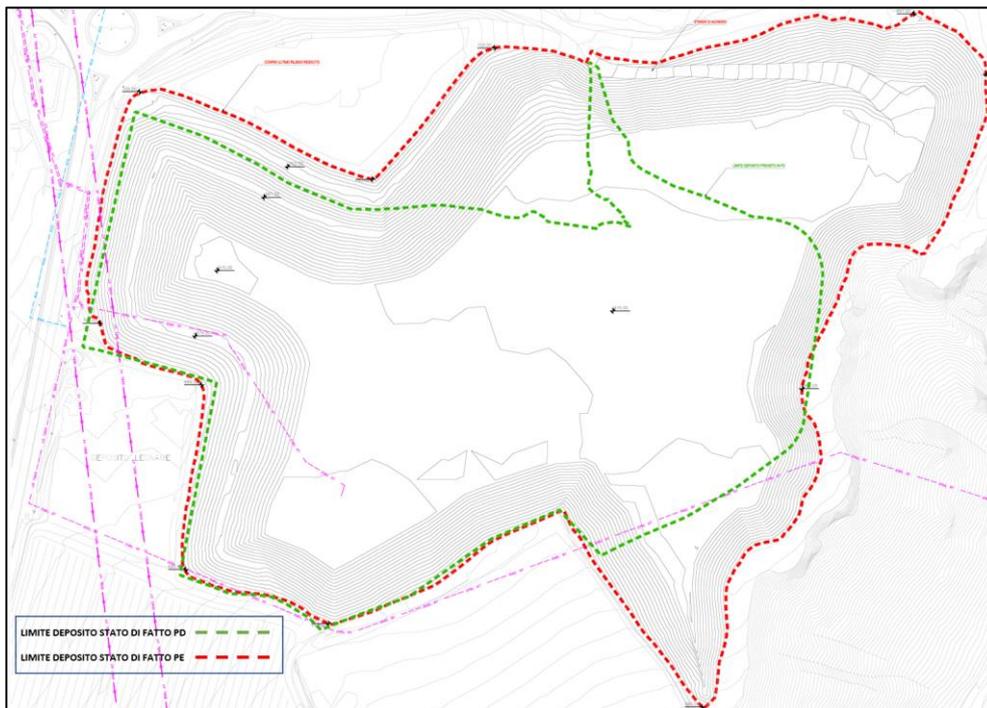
Planimetria Stato di fatto con confronto PD-PE – Forch I
